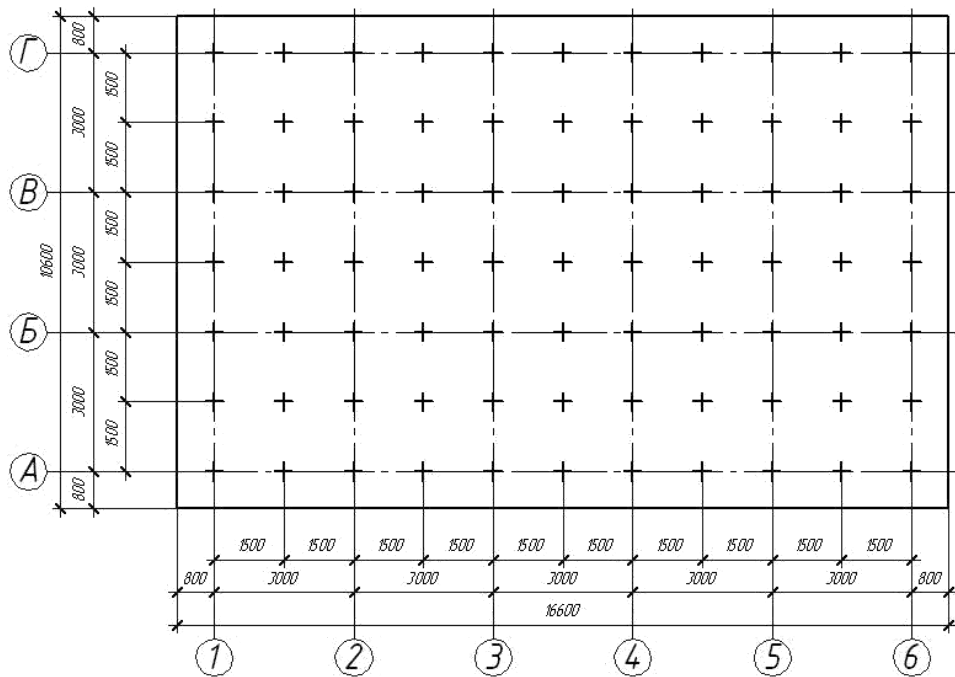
Схема розміщення палей під суцільну фундаментну плиту.
